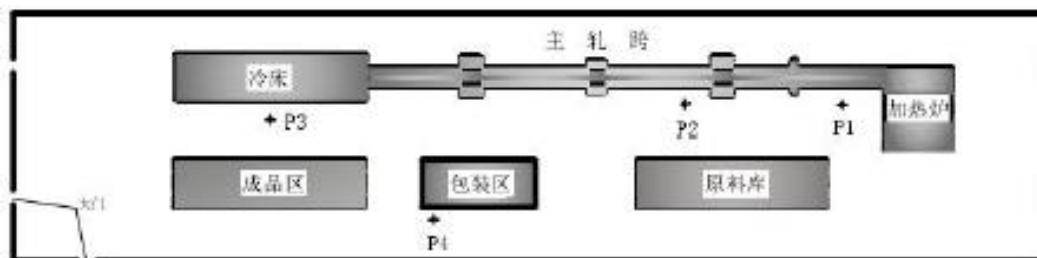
厂房热源布置及测点位置平面图（P 表示测点）
